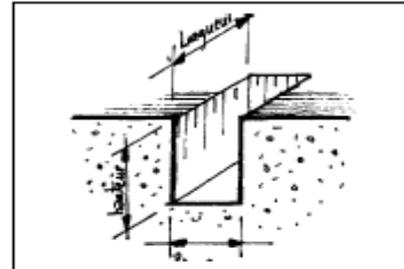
Fouilles en pleine masse ou en excavation : Il englobe des travaux d'envergure aussi bien en surface qu'en hauteur.
